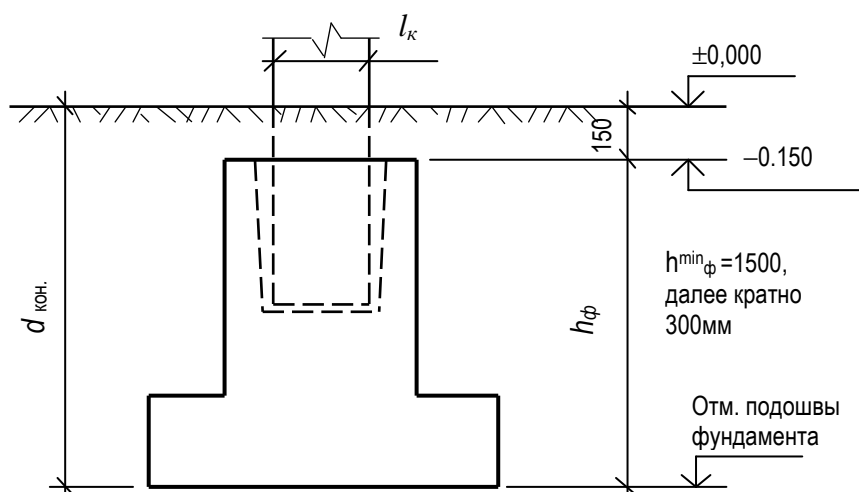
Предварительное конструирование отдельного (столбчатого), монолитного фундамента под сборную железобетонную колонну. Вариант – без подвала
